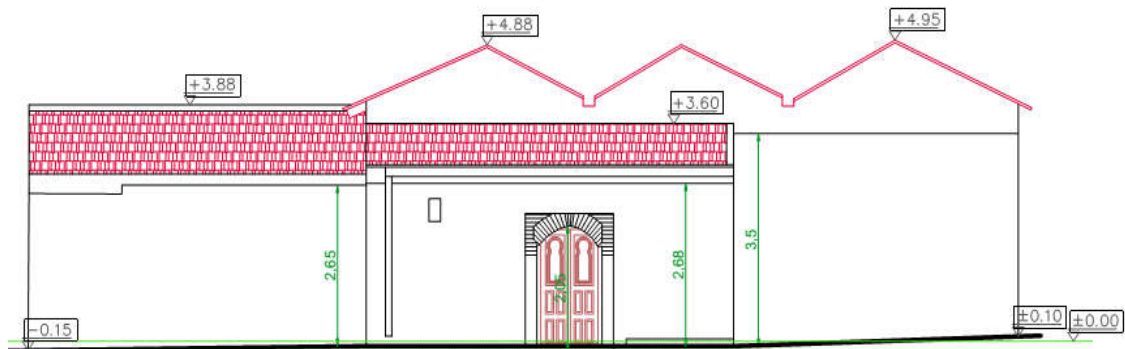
Plan de façade principale de la mosquée Sidi Bel Abbas.
